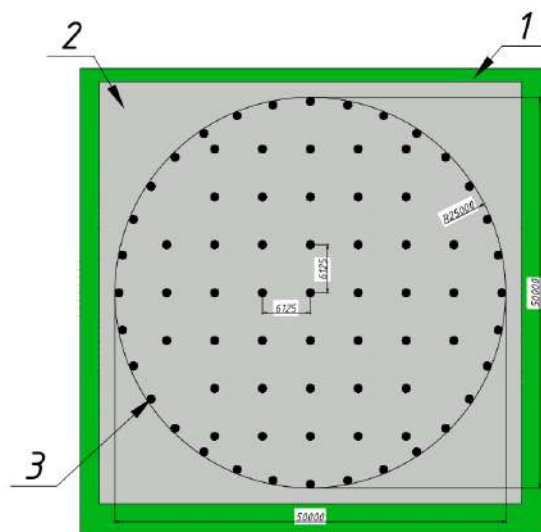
Устройство буронабивных свай. План расположения свай
